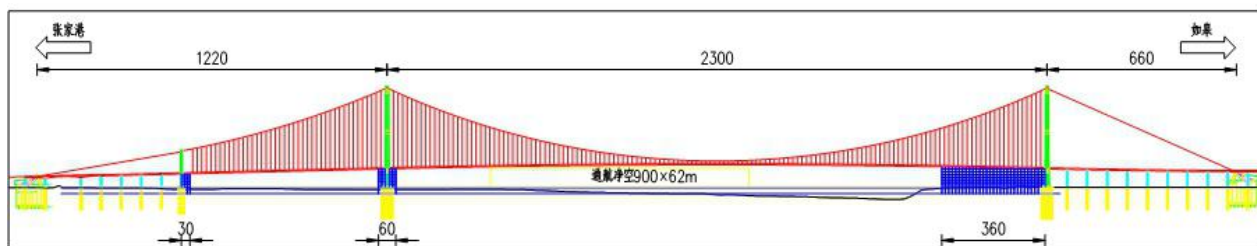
主江航道通航孔桥临时支架总体平面布置图
